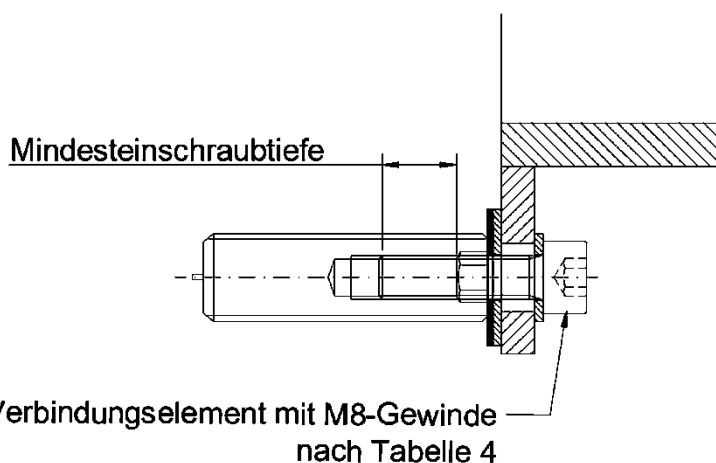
Schematische Darstellung der Mindestschraubtiefe am Beispiel eines Fix Max® Gewinde Anker – BS100 und einer Zylinderschraube mit Innensechskant
